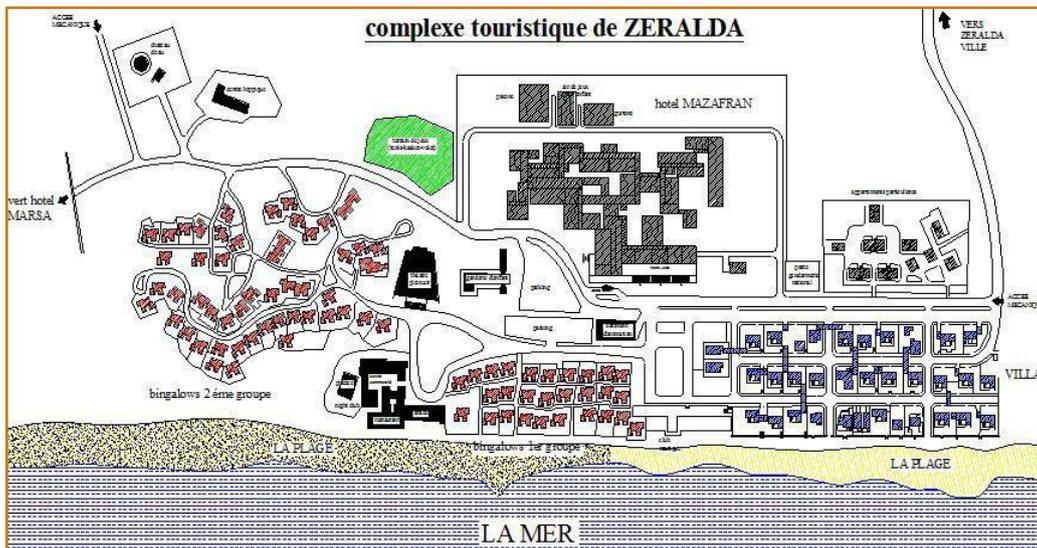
Plan de masse du complexe de Zéralda d'Alger.
